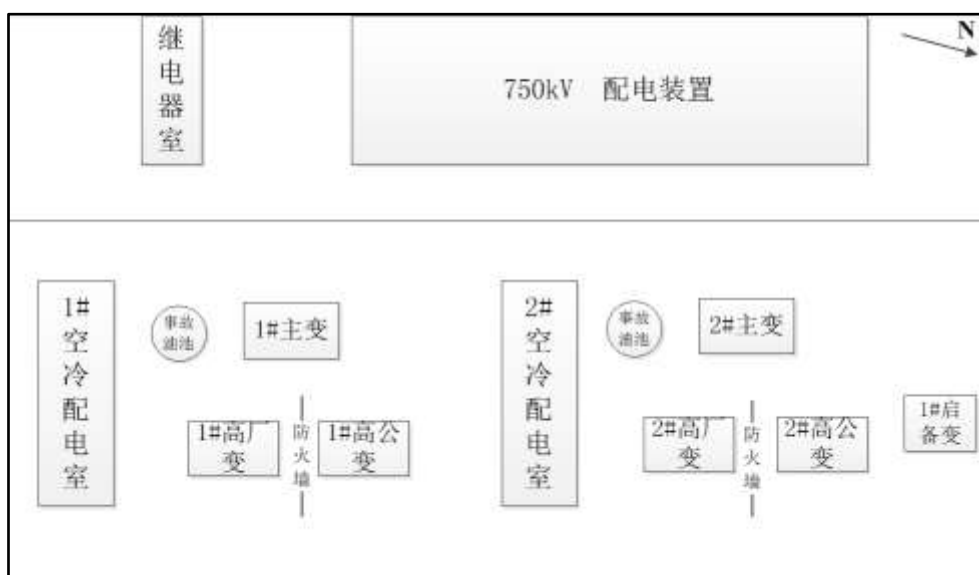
店塔电厂 750kV 升压站工程平面布置示意图
